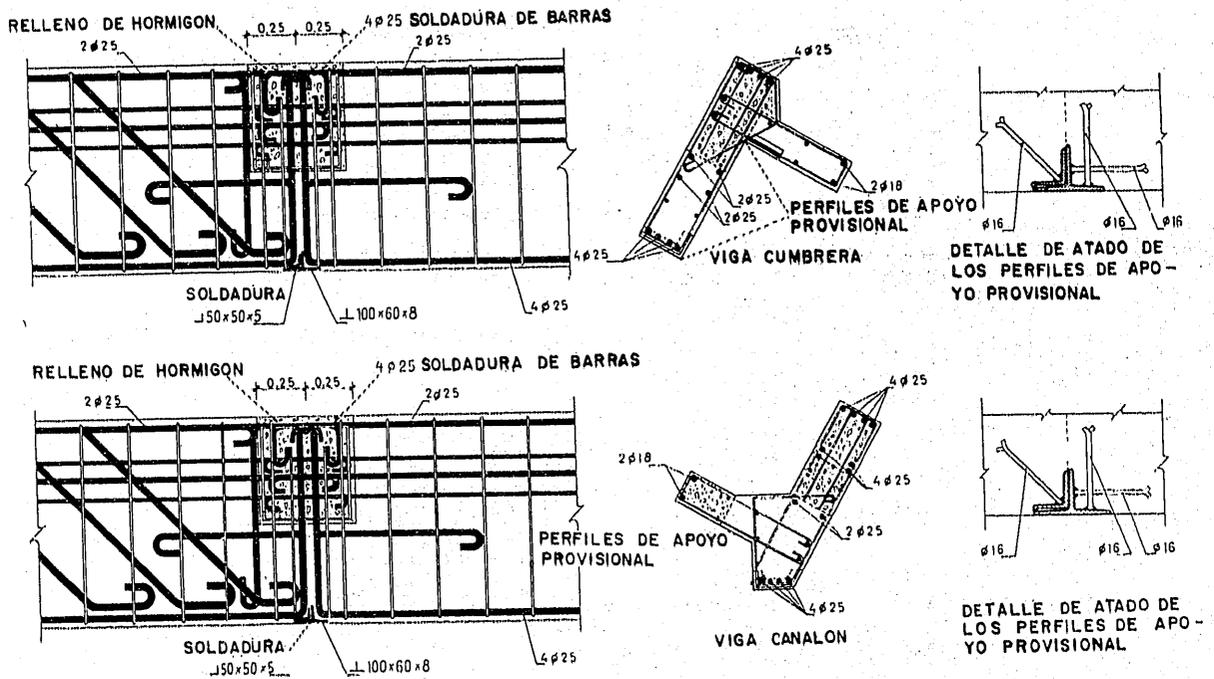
^a - Detalle de armaduras y zonas de relleno.
